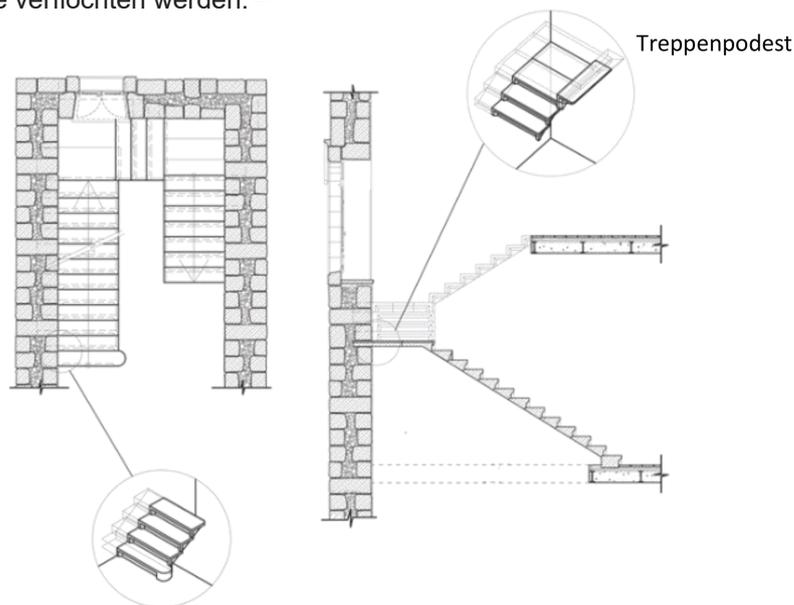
Kragstufentreppen- Grundriss & Schnitt
